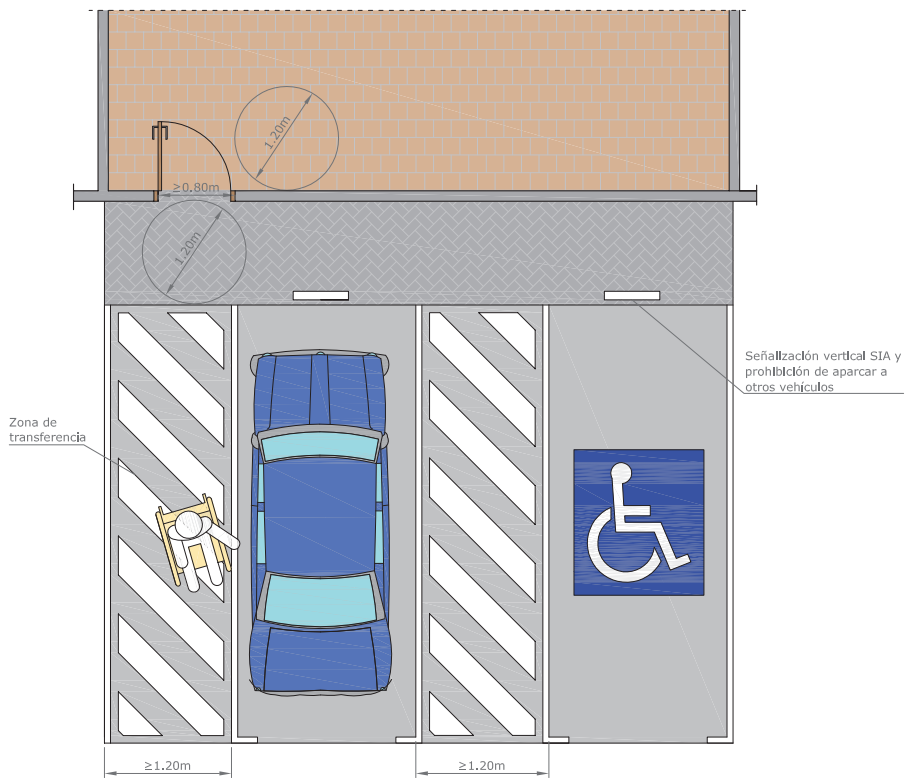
Aparcamiento reservado en batería junto a un edificio.
